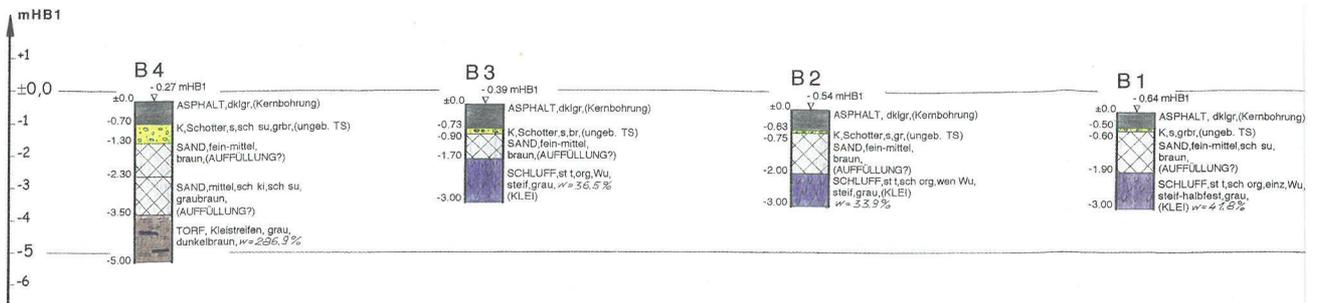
und 5. Bohrprofile der Erkundungen von 2004 einschließlich Lageplan der Erkundungspunkte
